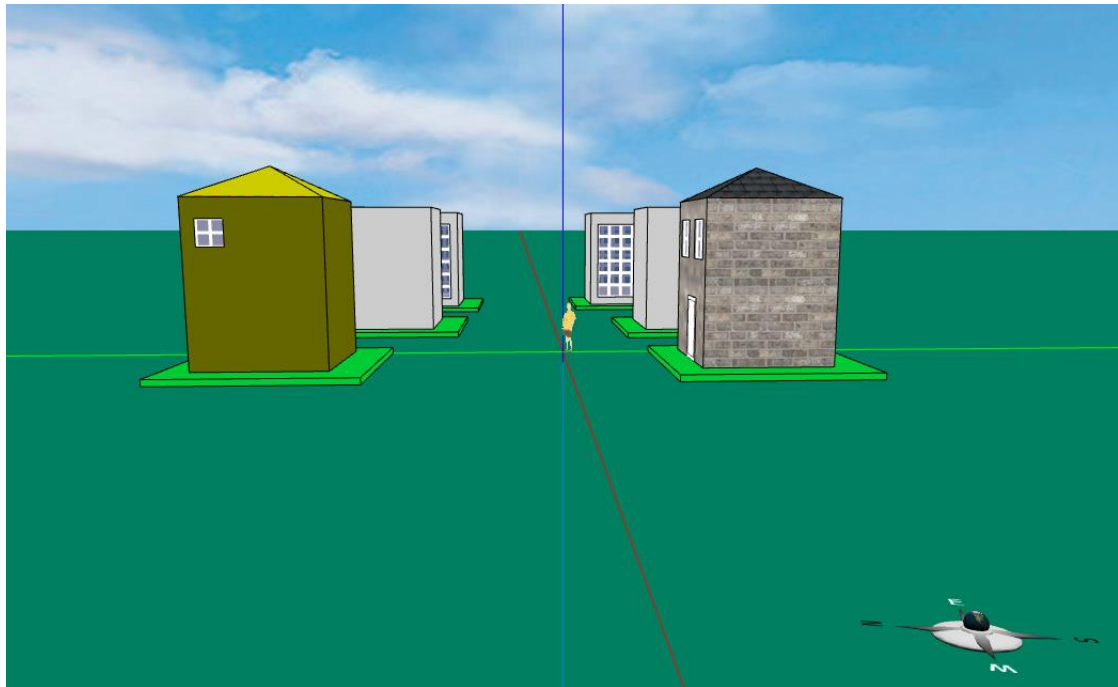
Construcciones de adobe y ladrillo Fuente: elaboración propia
